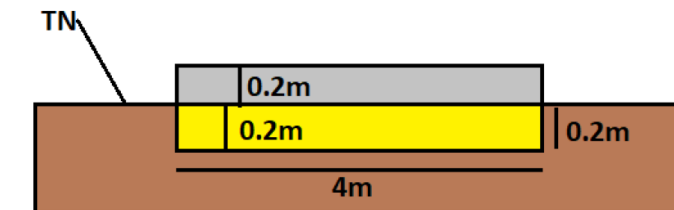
Coupe type voirie piste ourde (Source : Photosol)
